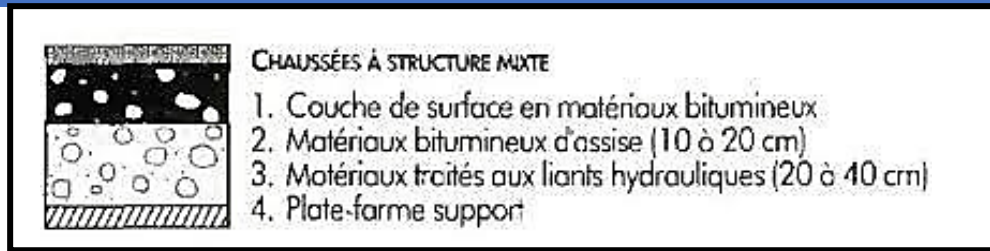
Coupe type d'une chaussée mixte (Chibani (2017)).
